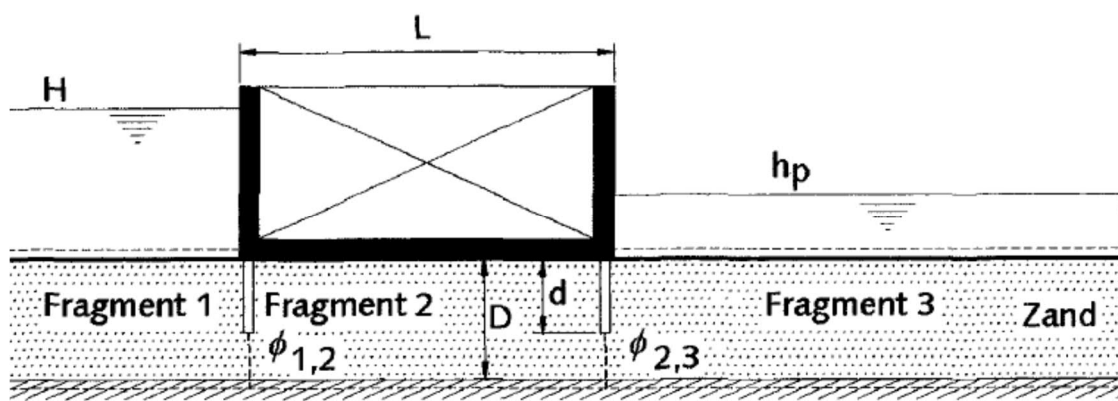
Voorbeeld bepaling lengte benedenstroomse kwelscherm
